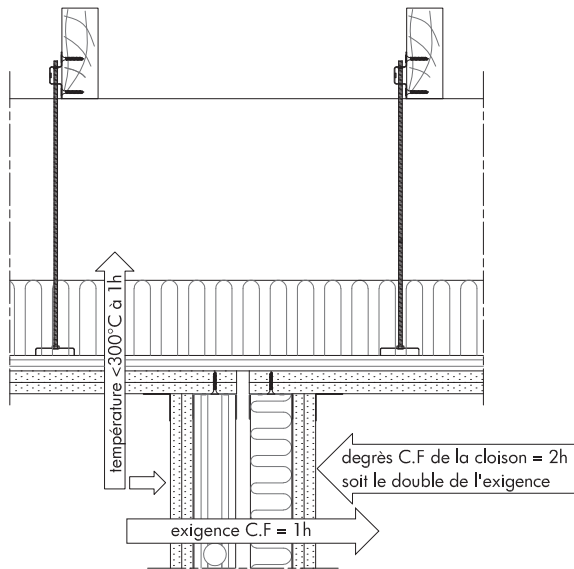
Cloisons fixées sous plafond - ERP type U
